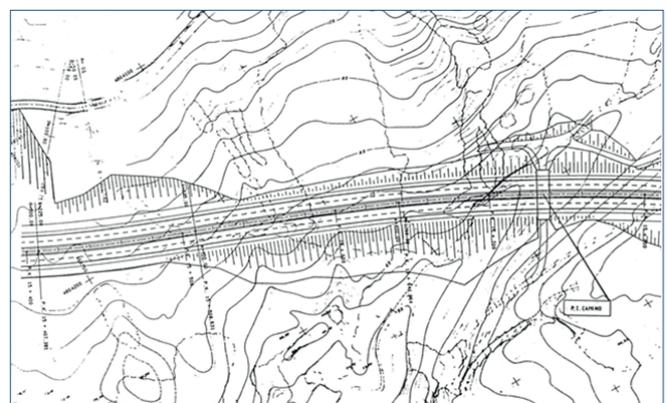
Planta de terraplén tomada del Proyecto de Construcción (1995)
